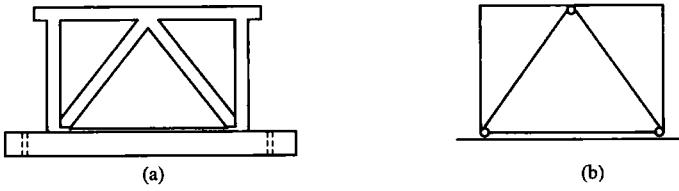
钢筋混凝土剪力撑结构雏形示意图
